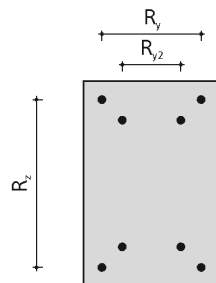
Bereich für weitere Bewehrungsstäbe bei ein- bzw. zweilagiger Bewehrungsanordnung
